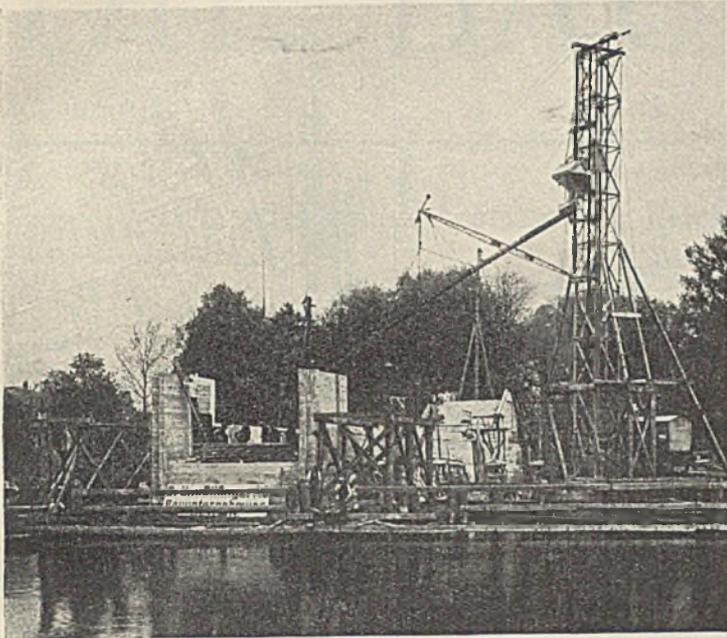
Betoniervorrichtung und wasserseitige Wangenmauern.
